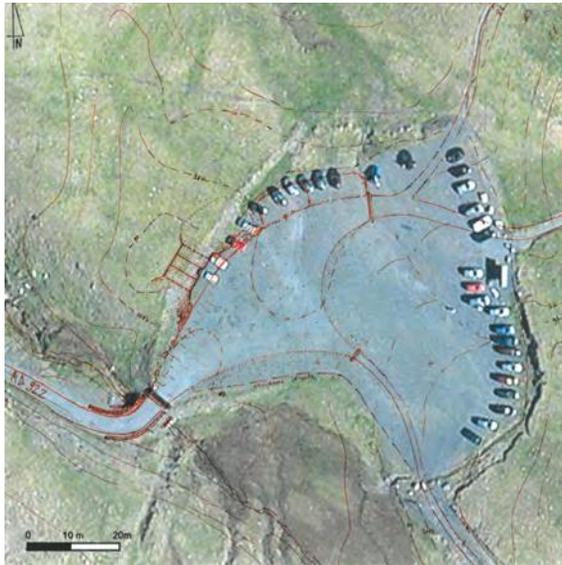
Plano general de las obras llevadas a cabo sobre el aparcamiento del circo de Troumouse
